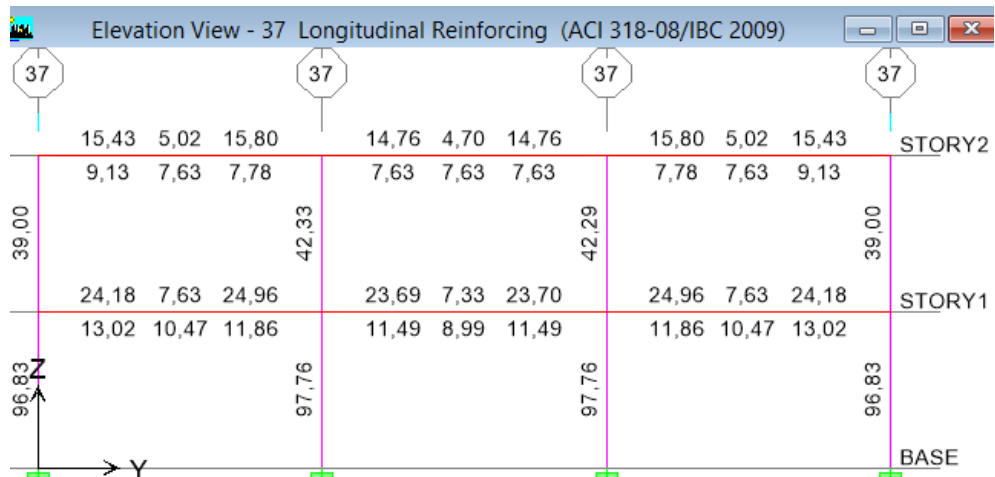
Acero en Vigas y Columnas en el Pórtico 37 – Obstetricia - (NEC-11)
